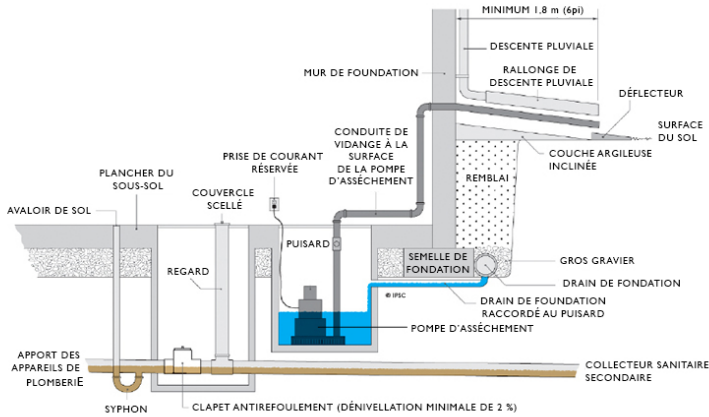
Installation d'un clapet antiretour (Source: IPSC)
